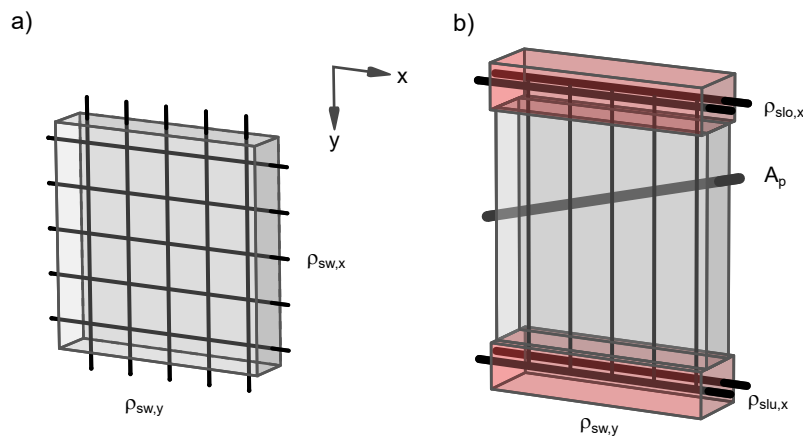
a) Scheibenelement bei gleichmäßiger, orthogonaler Bewehrungsverteilung b) Balkenabschnitt; Steg mit Schubbewehrung und kreuzendem Spannglied, durch Gurte eingefasst
